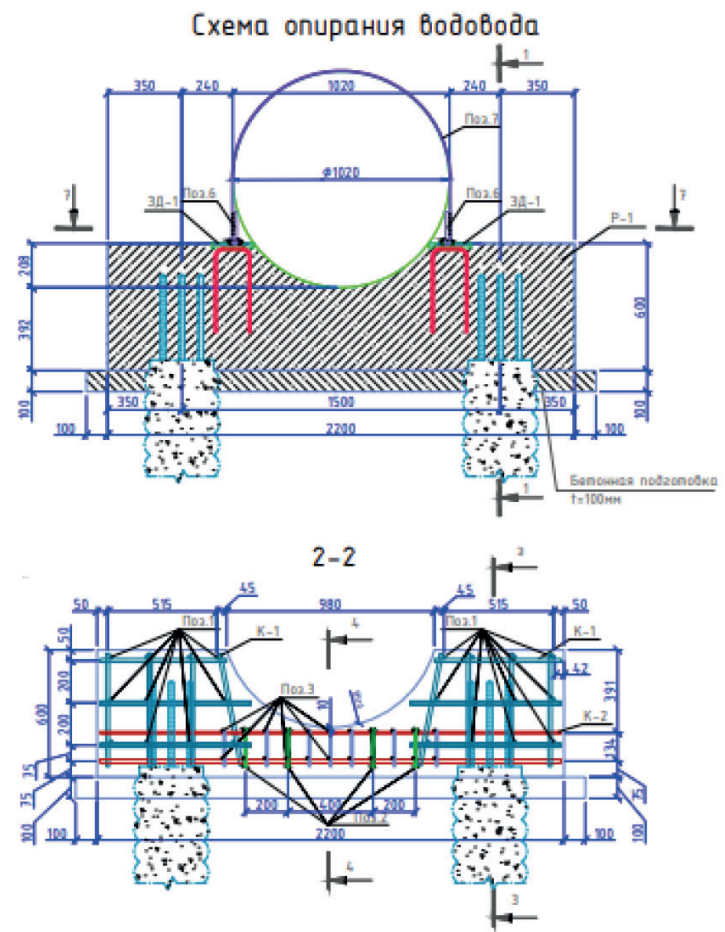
Узел передачи нагрузки от напорного трубопровода $d=1020$ мм на монолитный железобетонный ростверк
